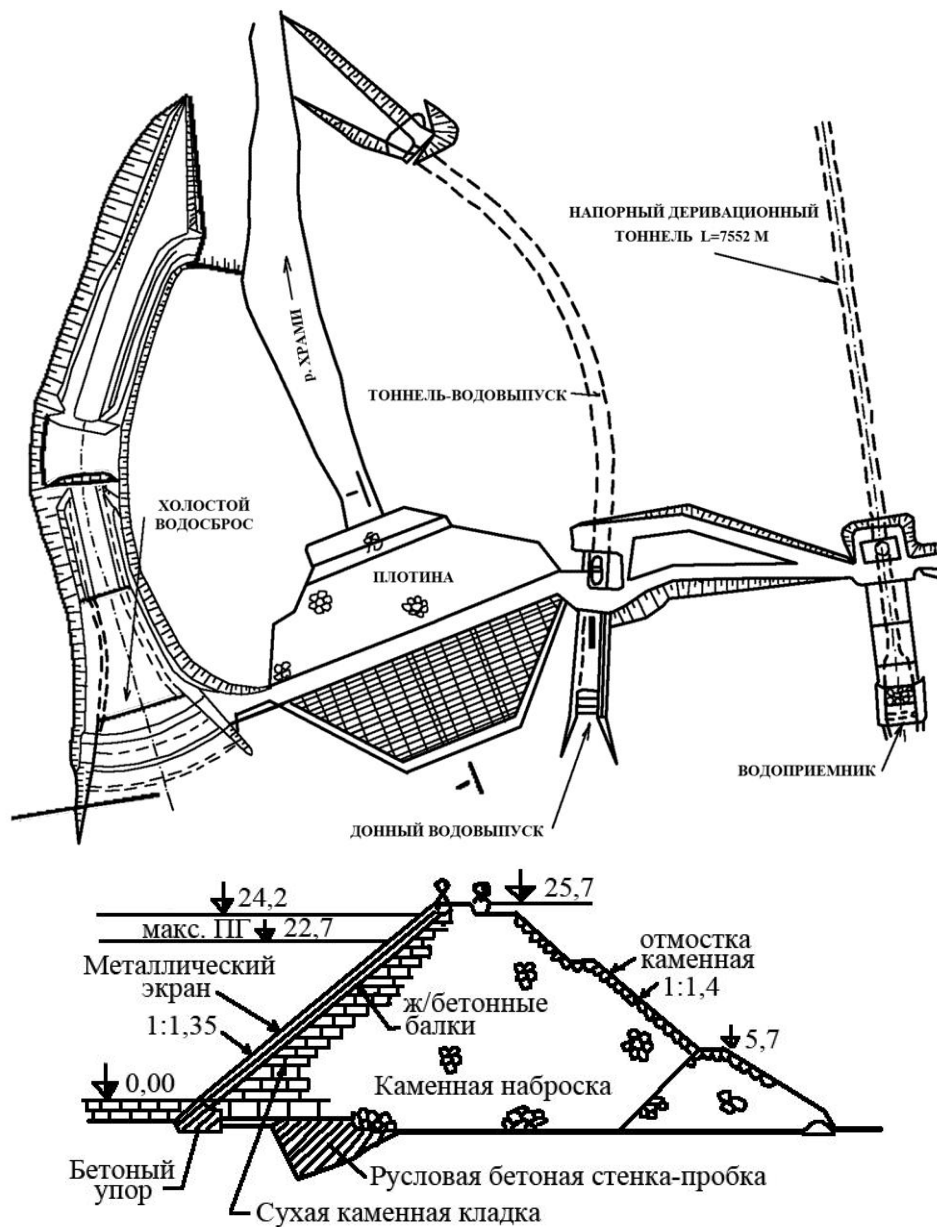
План головного узла и поперечный разрез плотины ХрамГЭС-I
